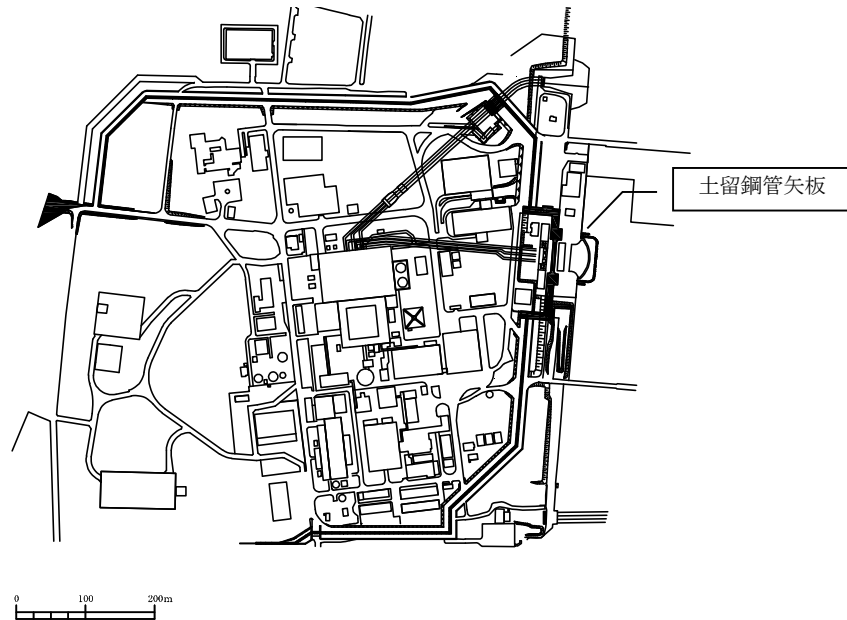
(1) 土留鋼管矢板の平面配置図 (全体図)
